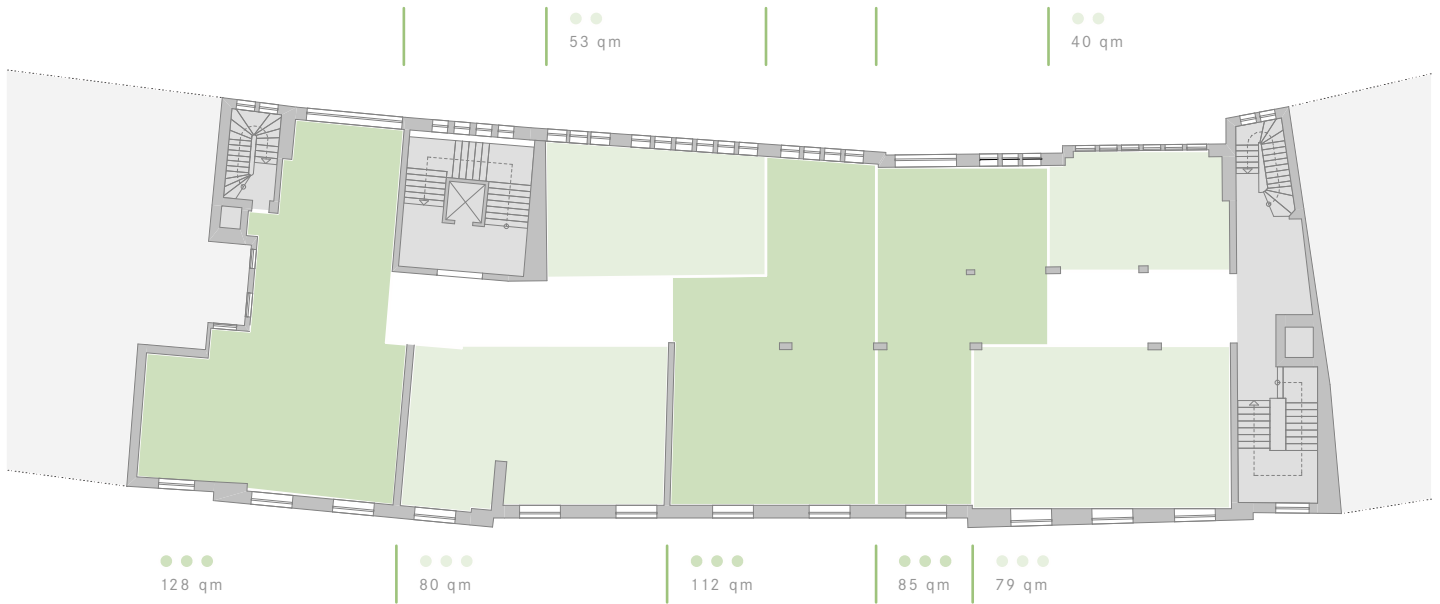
Grundriss Umbau - Wohnungsaufteilung
